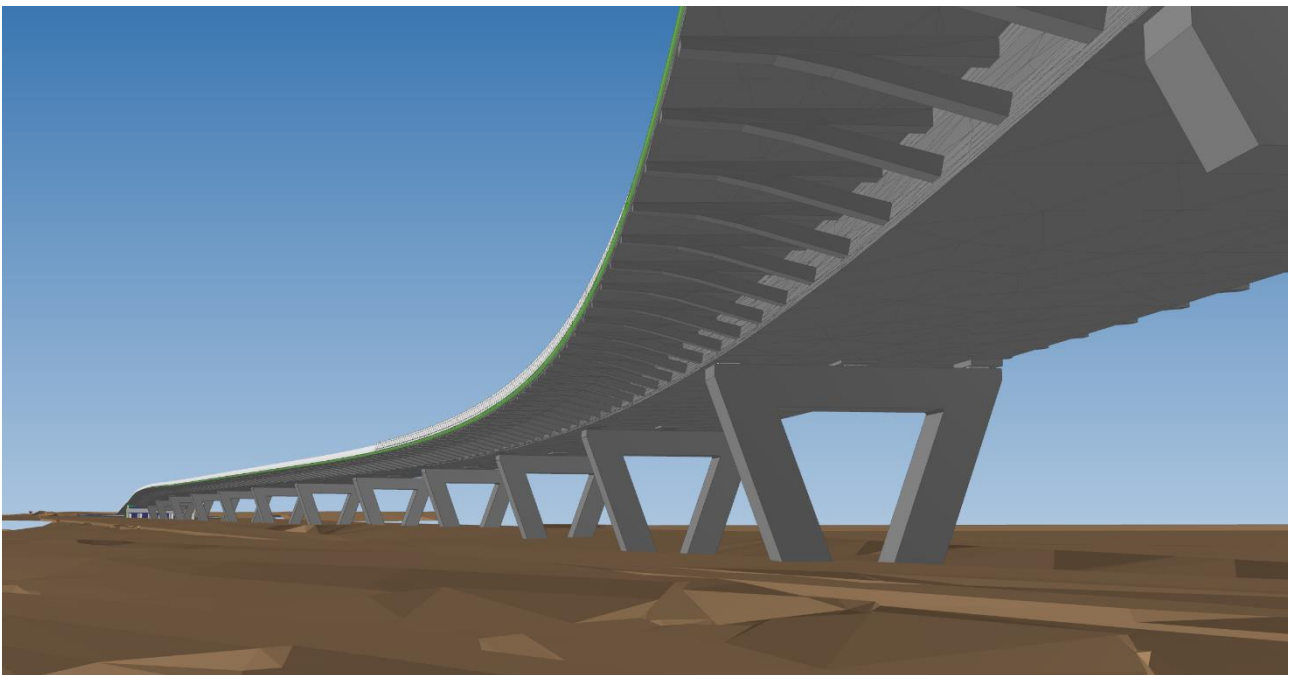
Infografía con la vista general del viaducto. Puede apreciarse el diseño de pilas y jabalcones.
